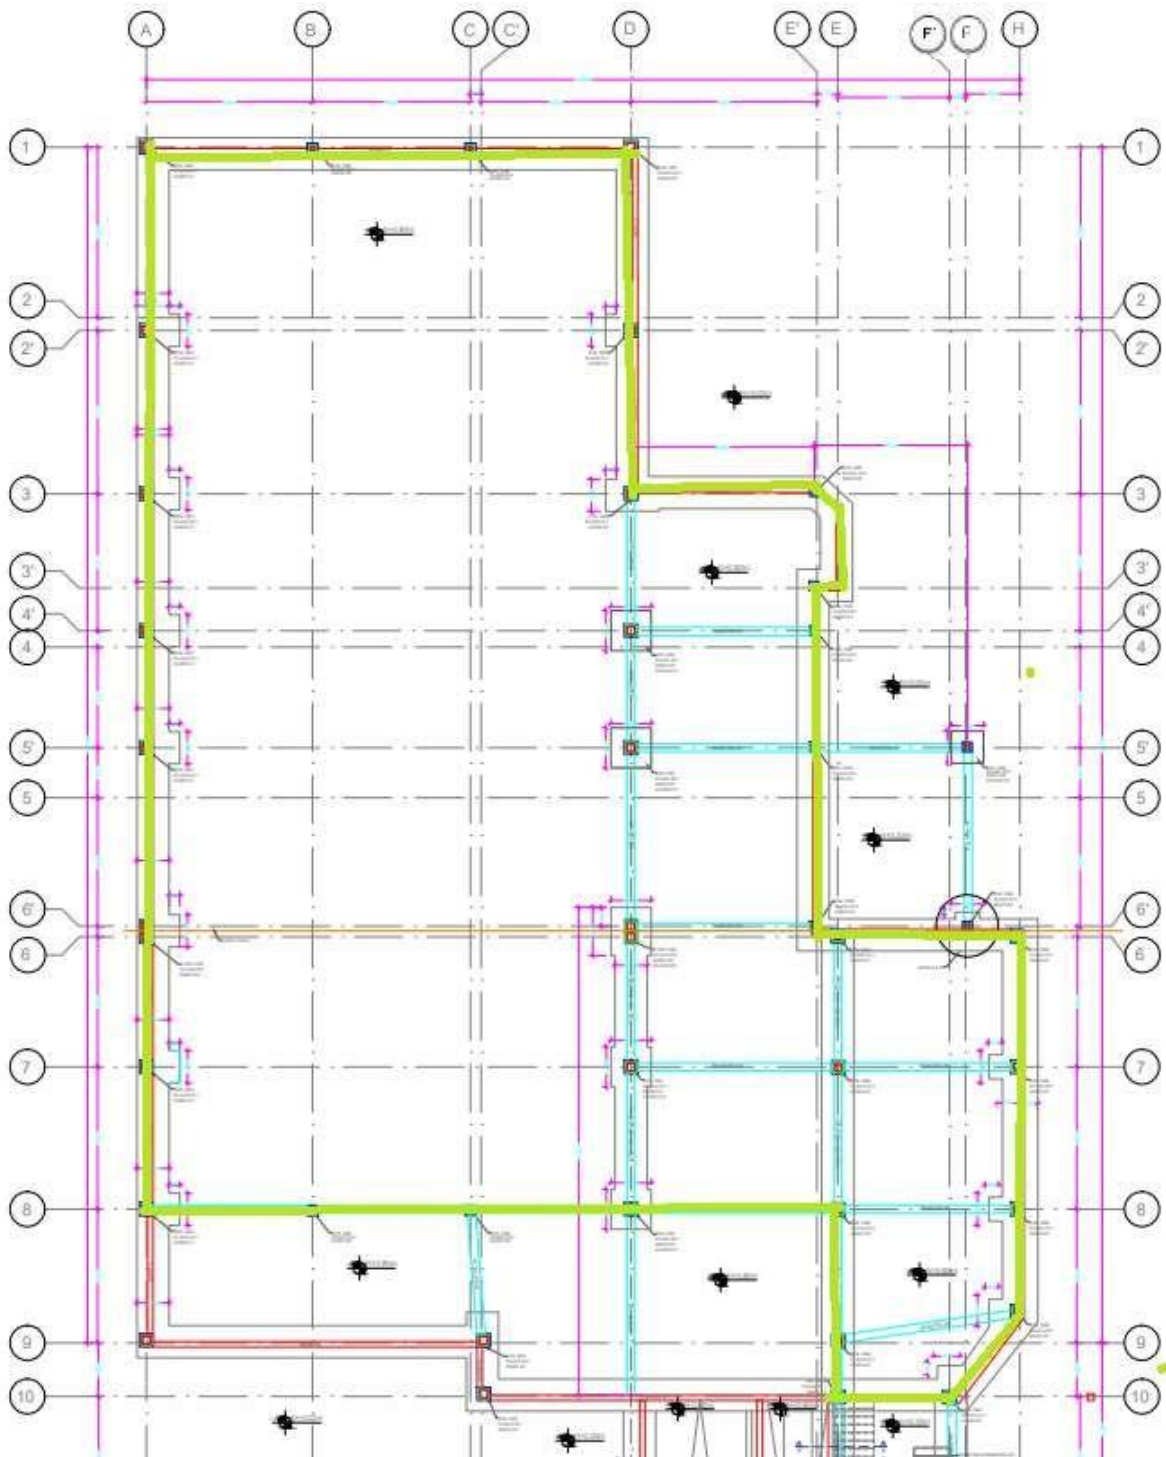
Plano estructural (Redwood & Paredes, 2023)
